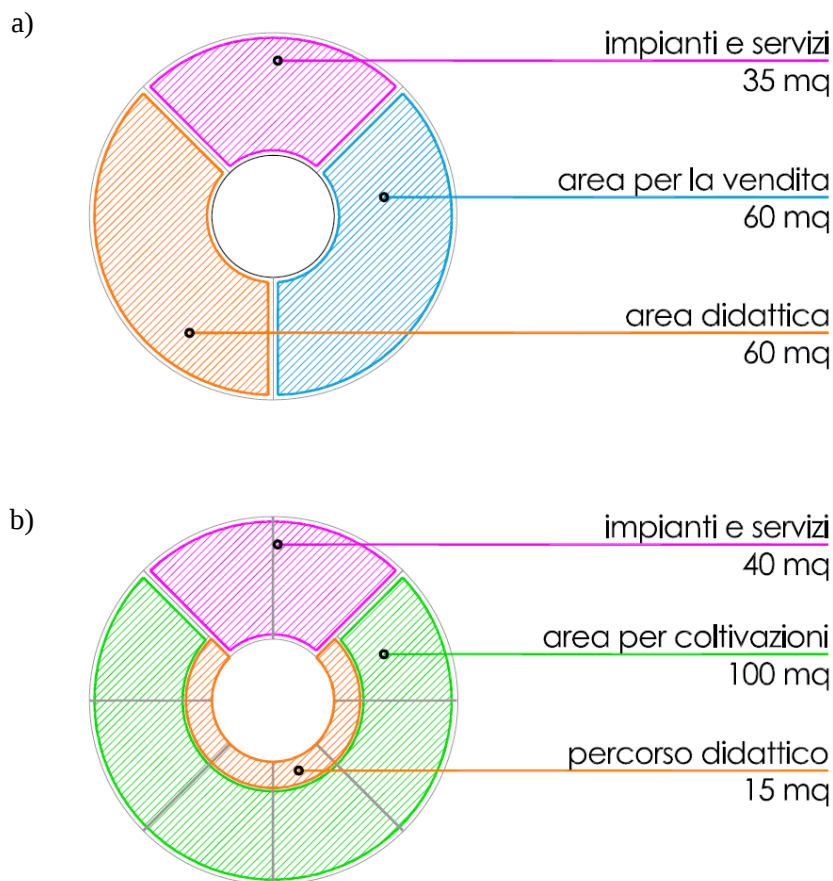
Torre Cilindrica, planimetria piano terra (a) e piano tipo (b) – distribuzione schematica delle funzioni
